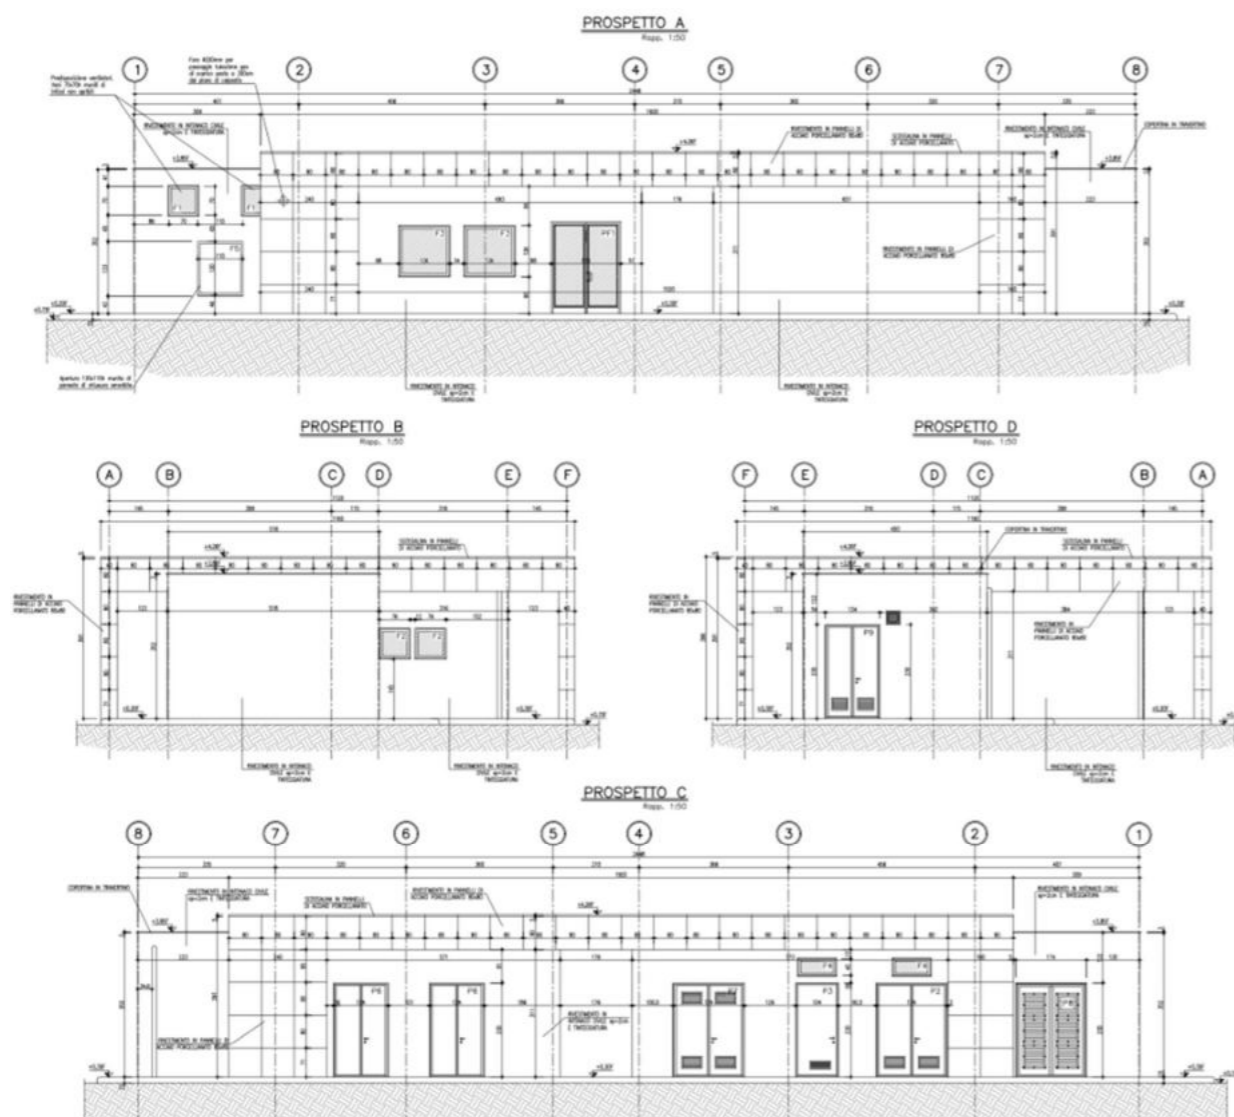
Fabbricato di stazione ed impianti - Pianta e Prospetti
